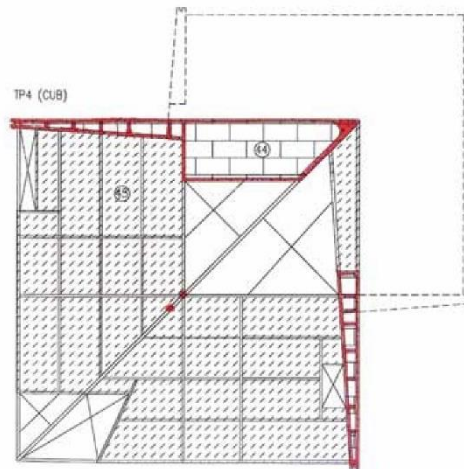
Información encontrada sobre estructura de la cubierta.
